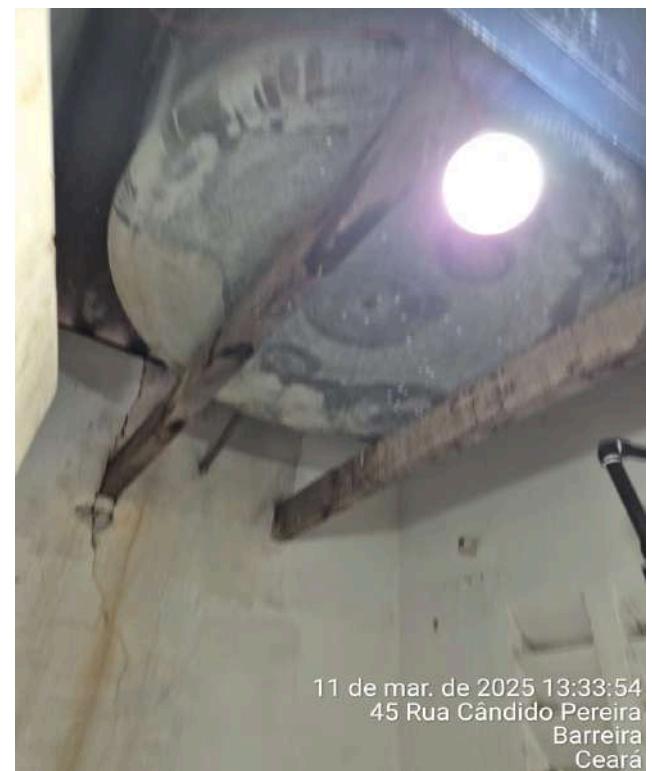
RAP-14 / REL-01 (Sede): apresentando falhas estruturais.
